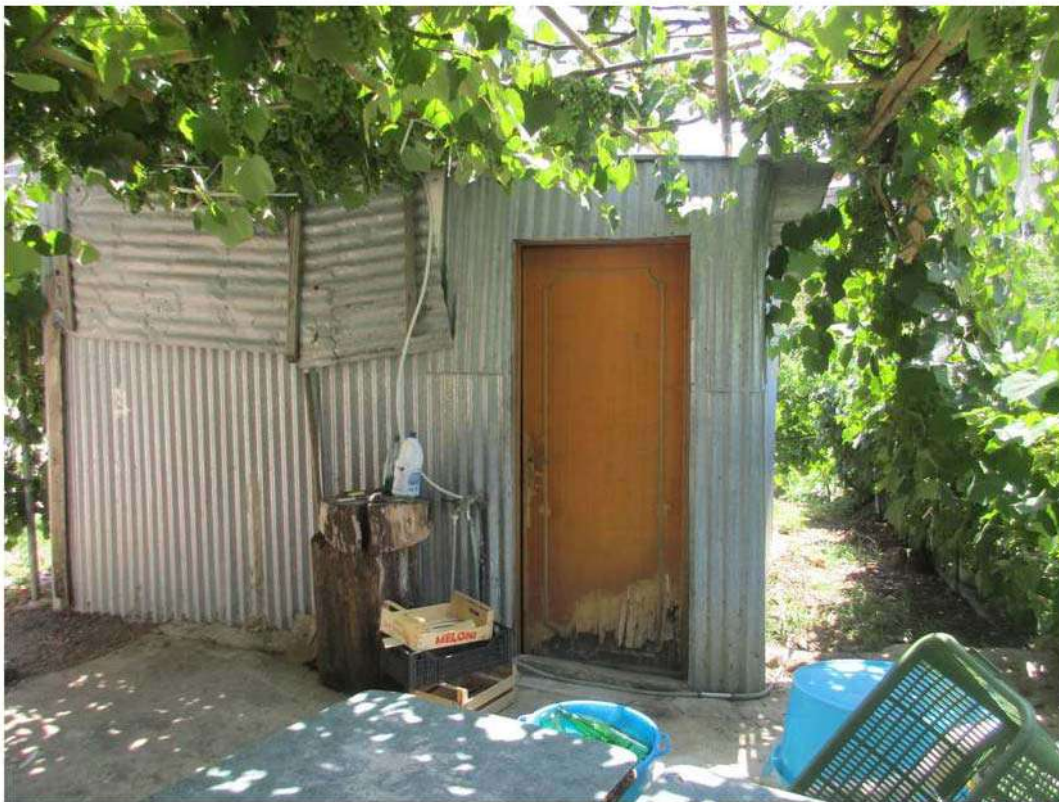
Una delle baracche in lamiera situate sul terreno (part. 912) in prossimità del fabbricato
